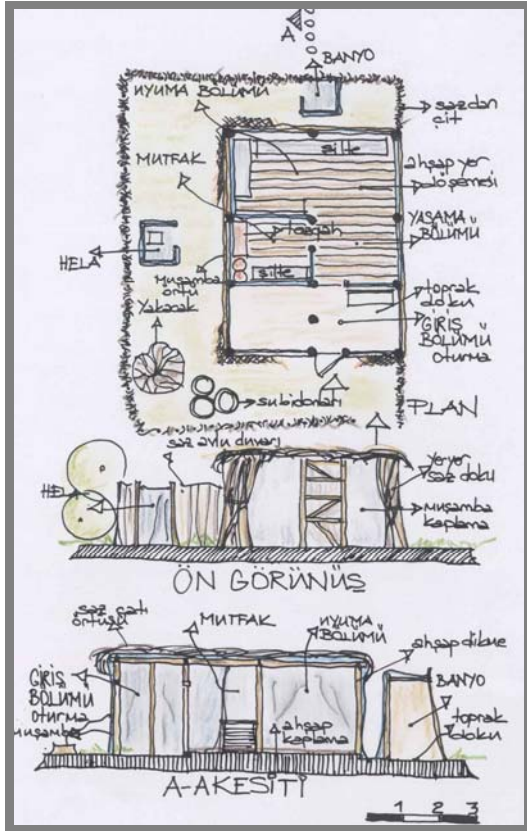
Mevcut durum 5 plan, kesit, görünüş
